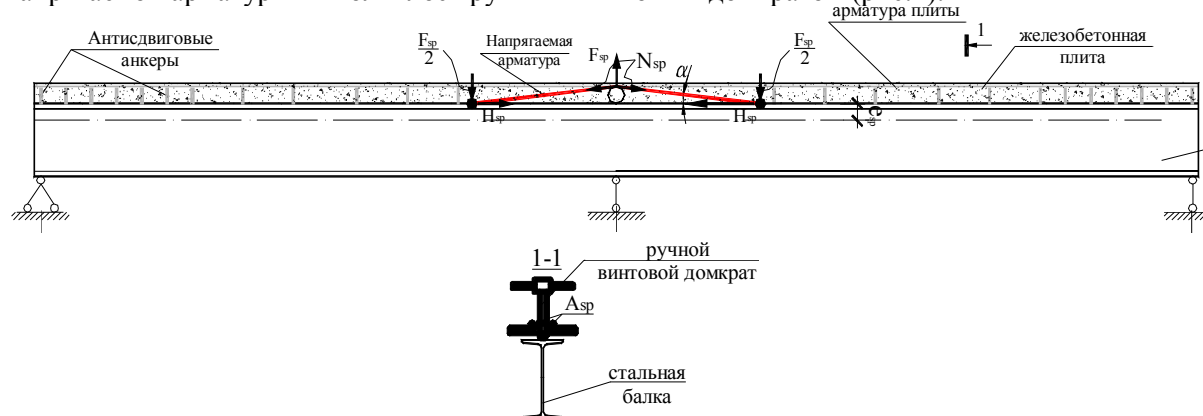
Сталежелезобетонная неразрезная балка с локальным обжатием только на опоре
